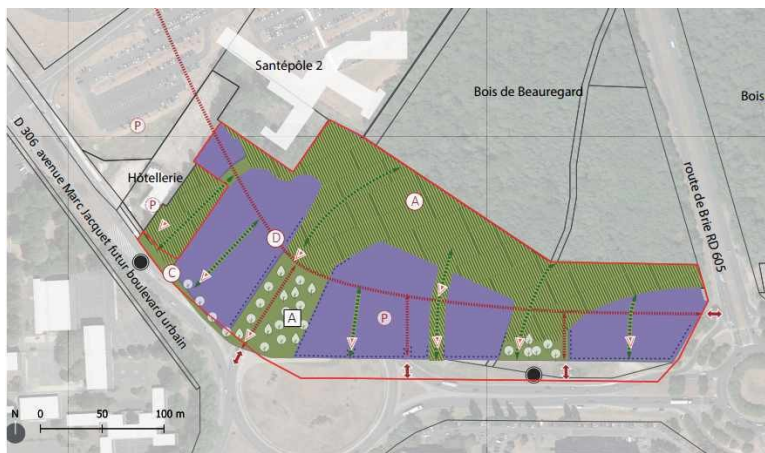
Plan de l'OAP Butte de Beauregard - Source OAP p. 27
